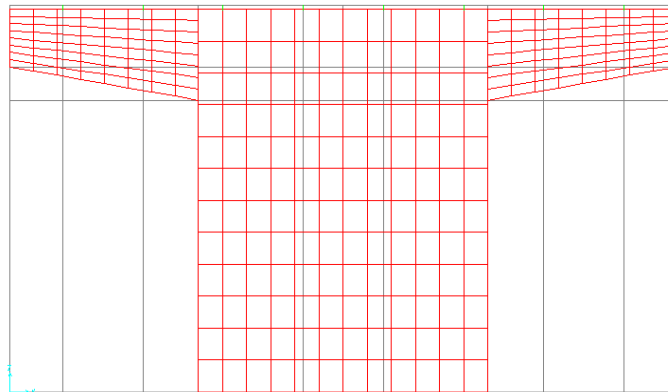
Áreas de la sección transversal de los muros intermedios (SAP2000).
